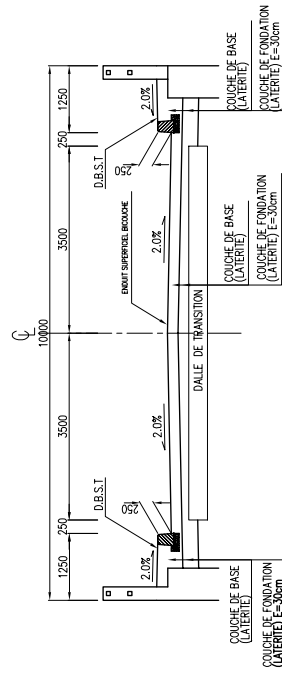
20 DETAIL B-B ECH 1:5
